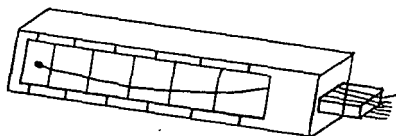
ESTRUCTURA DE CONCRETO PRESFORZADO.
